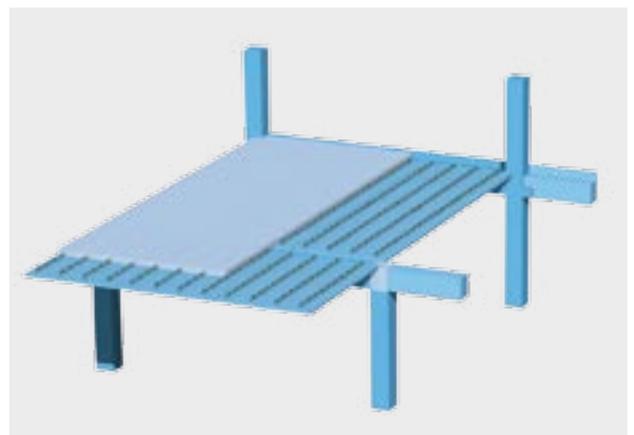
b: Elementdecken mit Halbfertigteil-Unterzug
